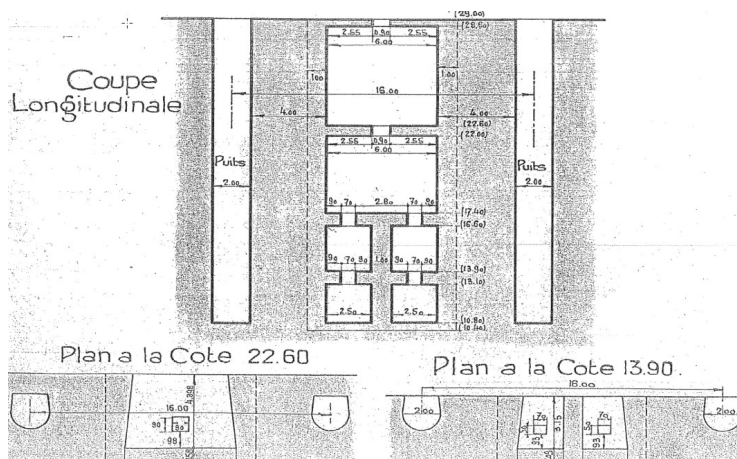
PLAN DE PRINCIPE DE LA CHAMBRE BÉTON
